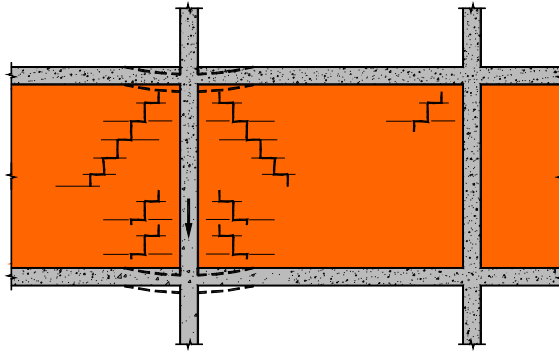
Assentamentos diferenciais entre pilares: surgem fissuras inclinadas na direcção do pilar que sofreu maior recalque [30]
